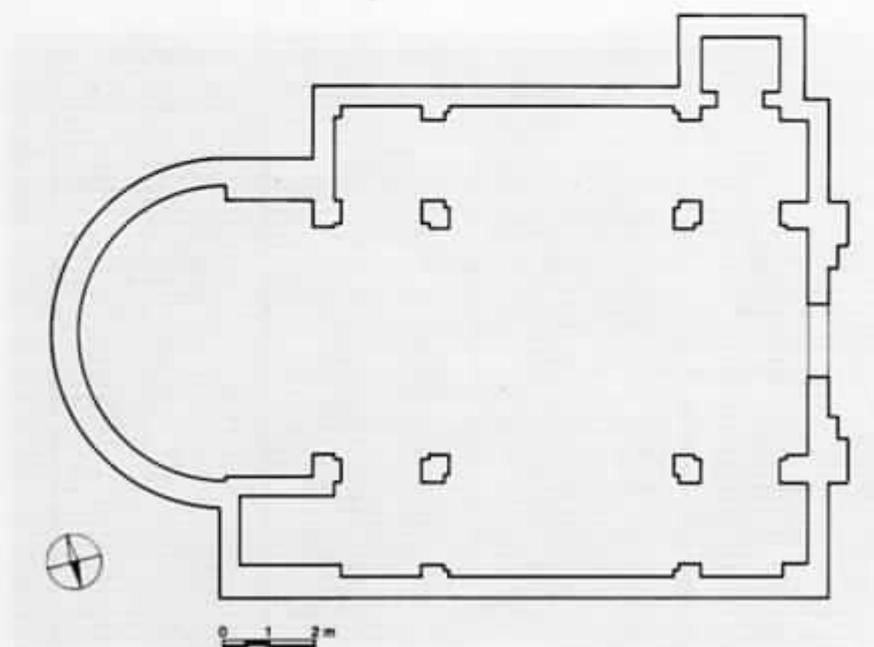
Pianta dell'attuale Chiesa (disegno Brunetti-Sangiorgi)
